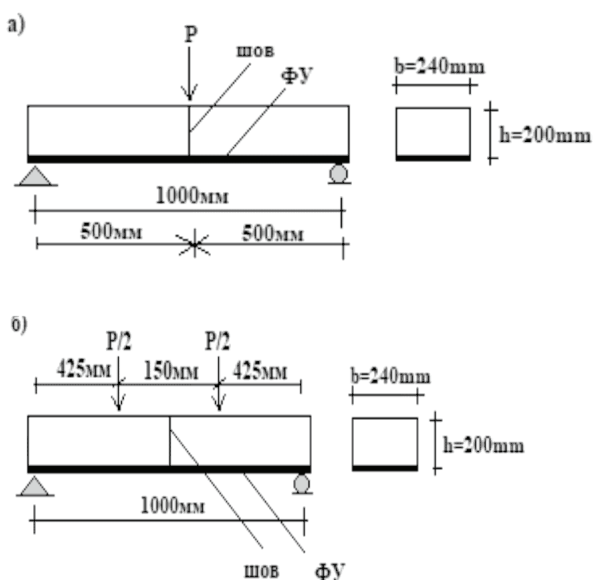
Схема испытания газобетонных перемычек: с армированием а) одноточечная нагрузка; б) двухточечная нагрузка.
